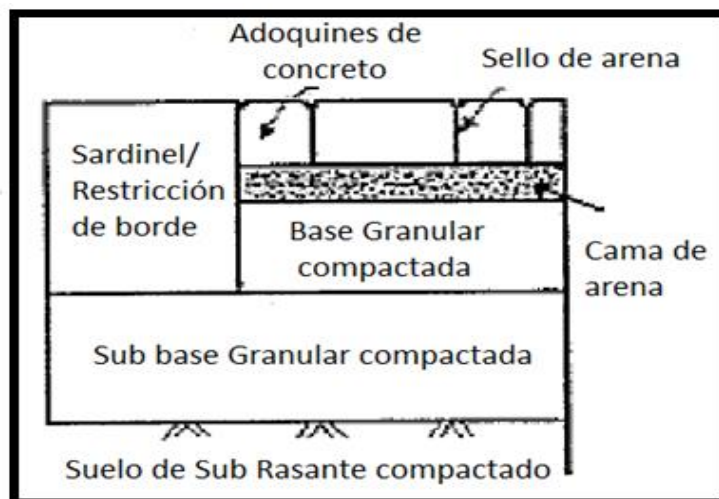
Sección transversal típica de los pavimentos de adoquines. (Norma Técnica C.E. 010 de Pavimentos Urbanos)
